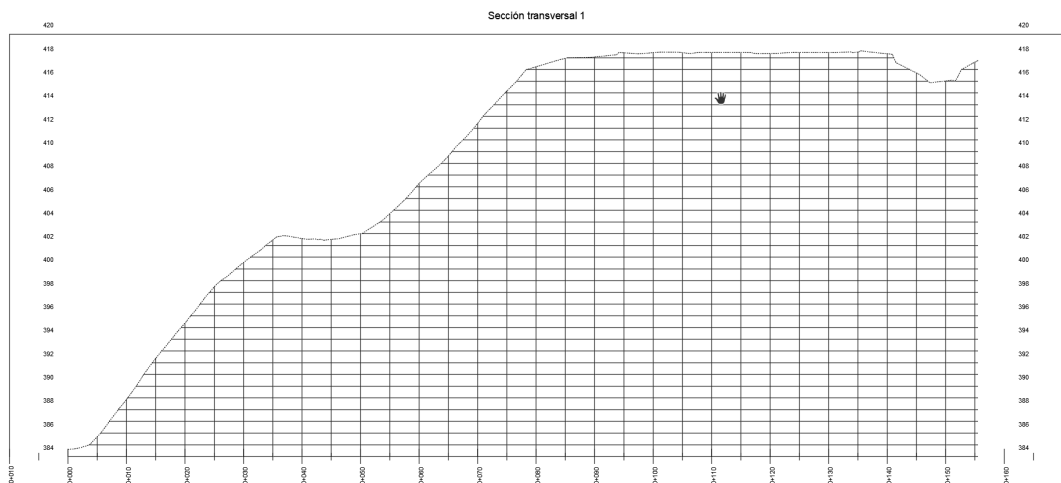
60. Sección transversal 1 finalizada.
